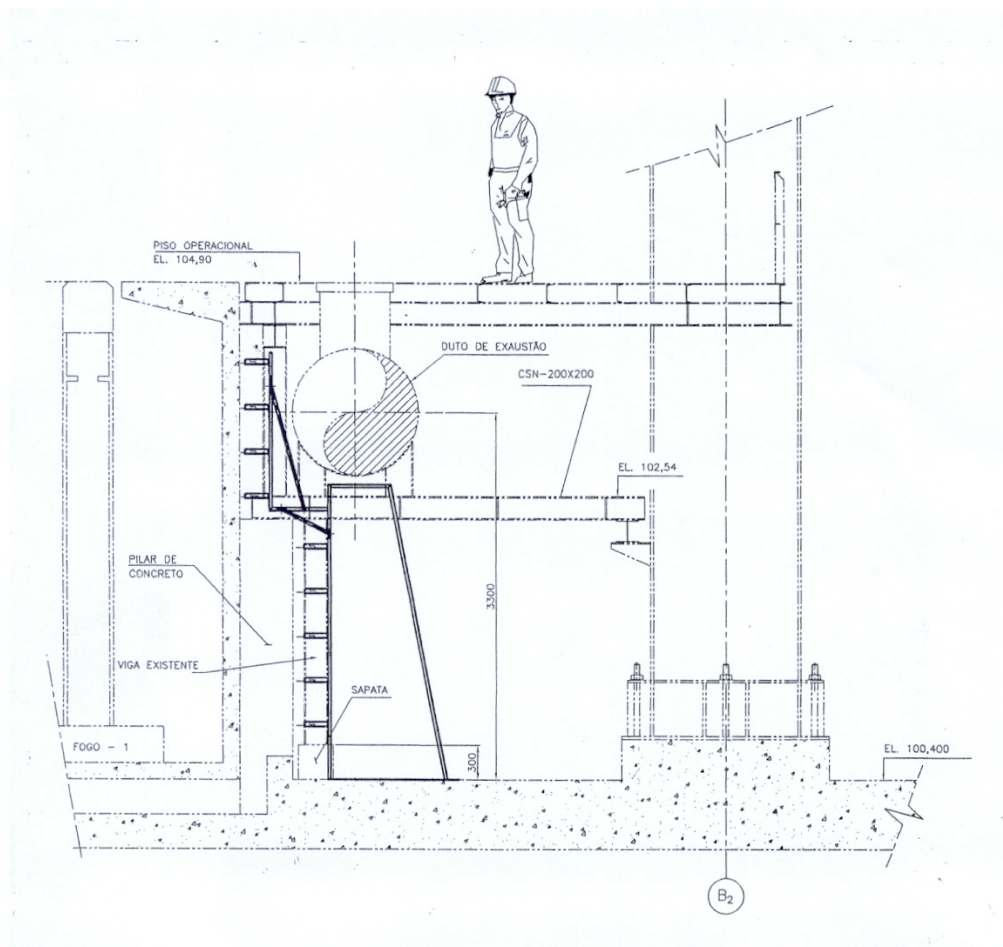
Ilustração do sistema: parede – suporte metálico
